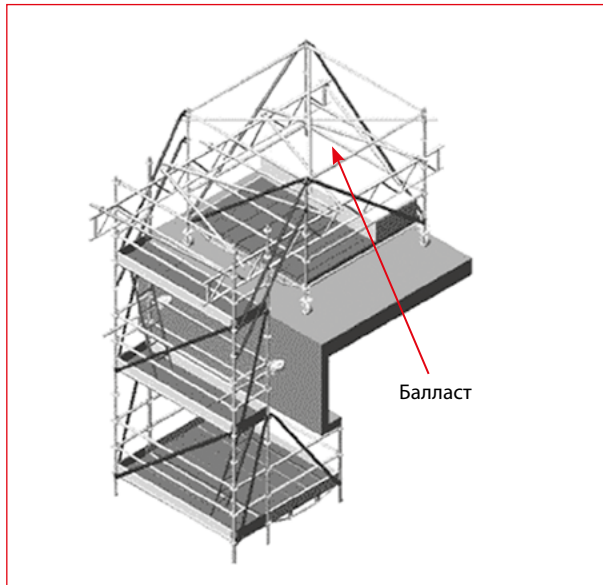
Способ монтажа подвесных строительных лесов
